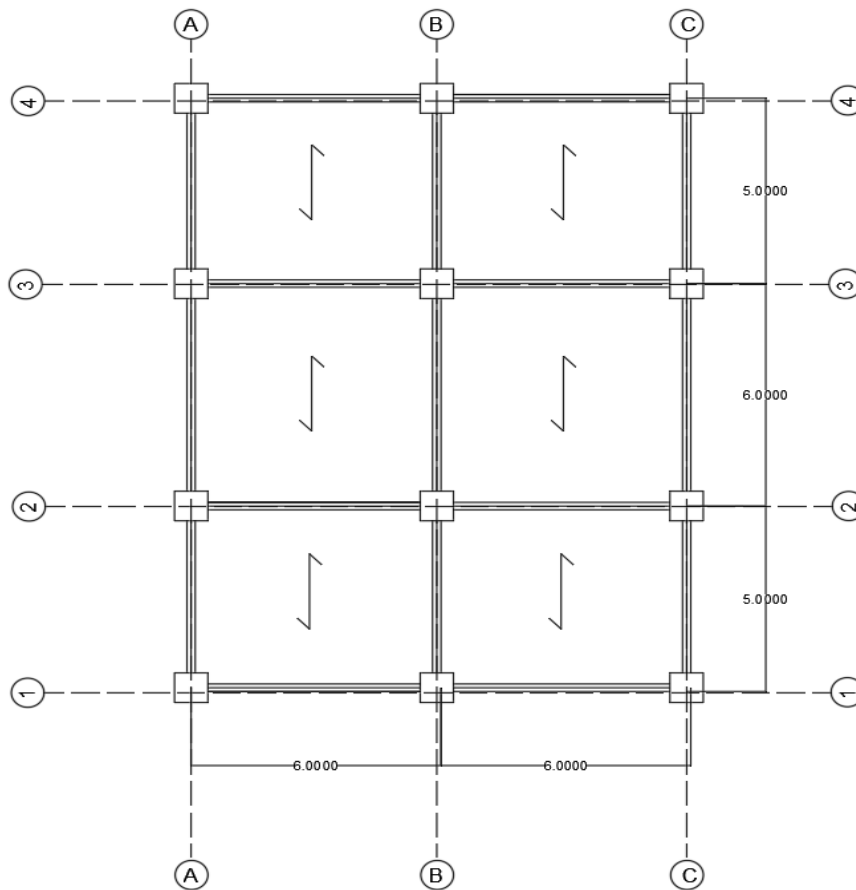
Vista en planta de la estructura (igual para cada piso). Autor: David González
